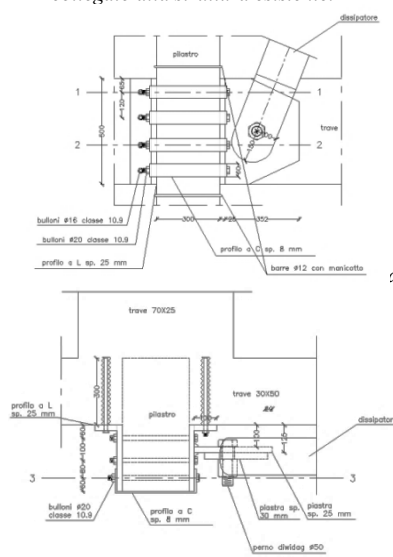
Particolare collegamento del controvento: a) vista frontale; b) sezione 1-1 del nodo.
